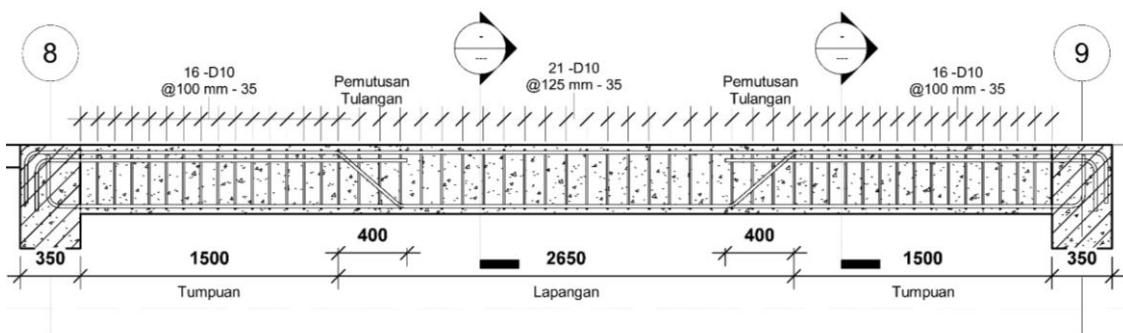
Ilustrasi 3D detailing memanjang penulangan balok induk
